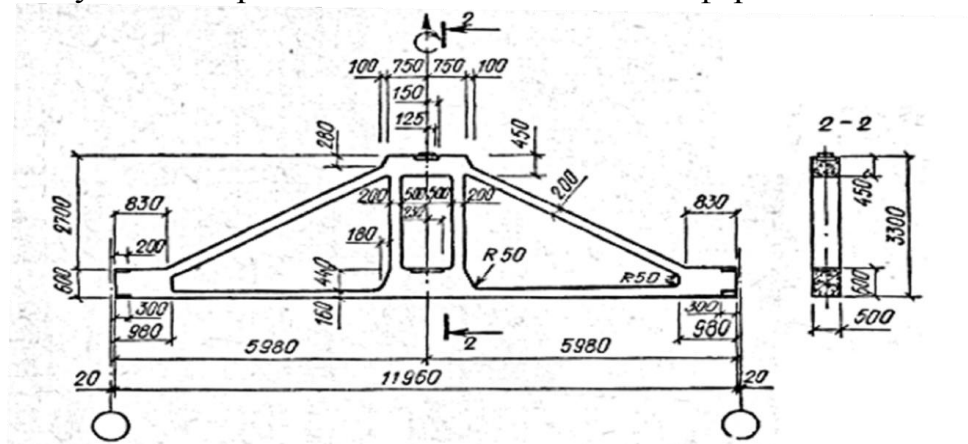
Подстропильная ферма для малоуклонной кровли
